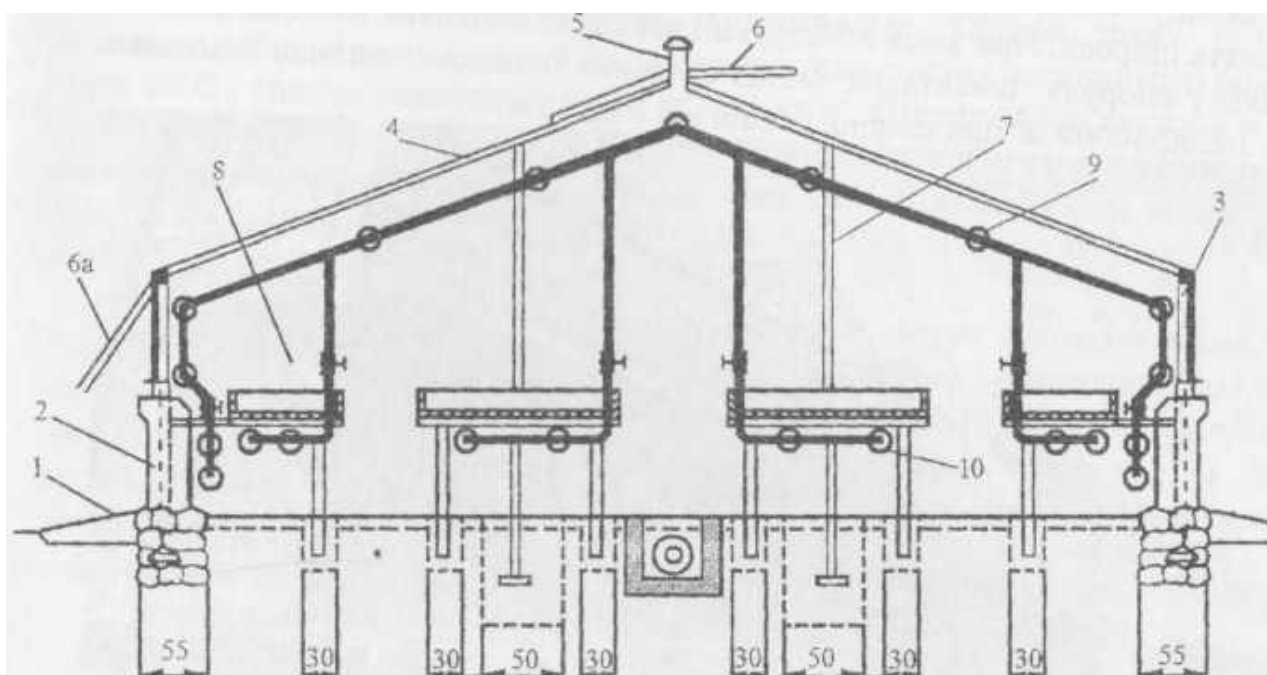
Поперечний розріз ангарної теплиці: 1 - фундамент; 2 - цоколь; бічна засклена стіна; 4 - засклена покрівля; 5 - гребенева балка; 6 - фрамуга; кватирка; 7 - стояк; 8 - стелажі; 9, 10 - труби водяного обігріву.
